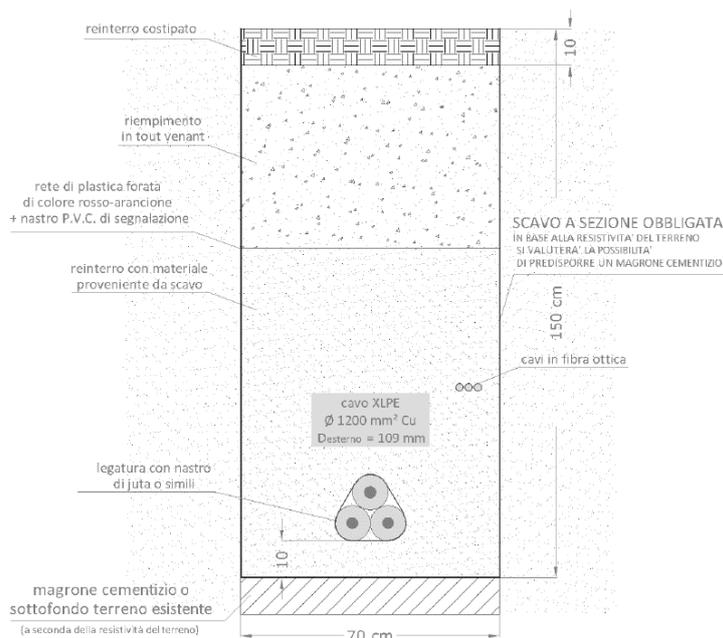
Tipico di posa di cavo in corrente alternata
